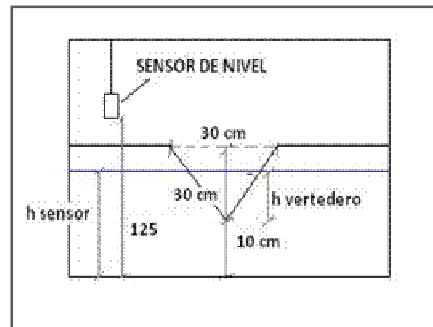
Esquema de vertedero instalado en Cámara 2
